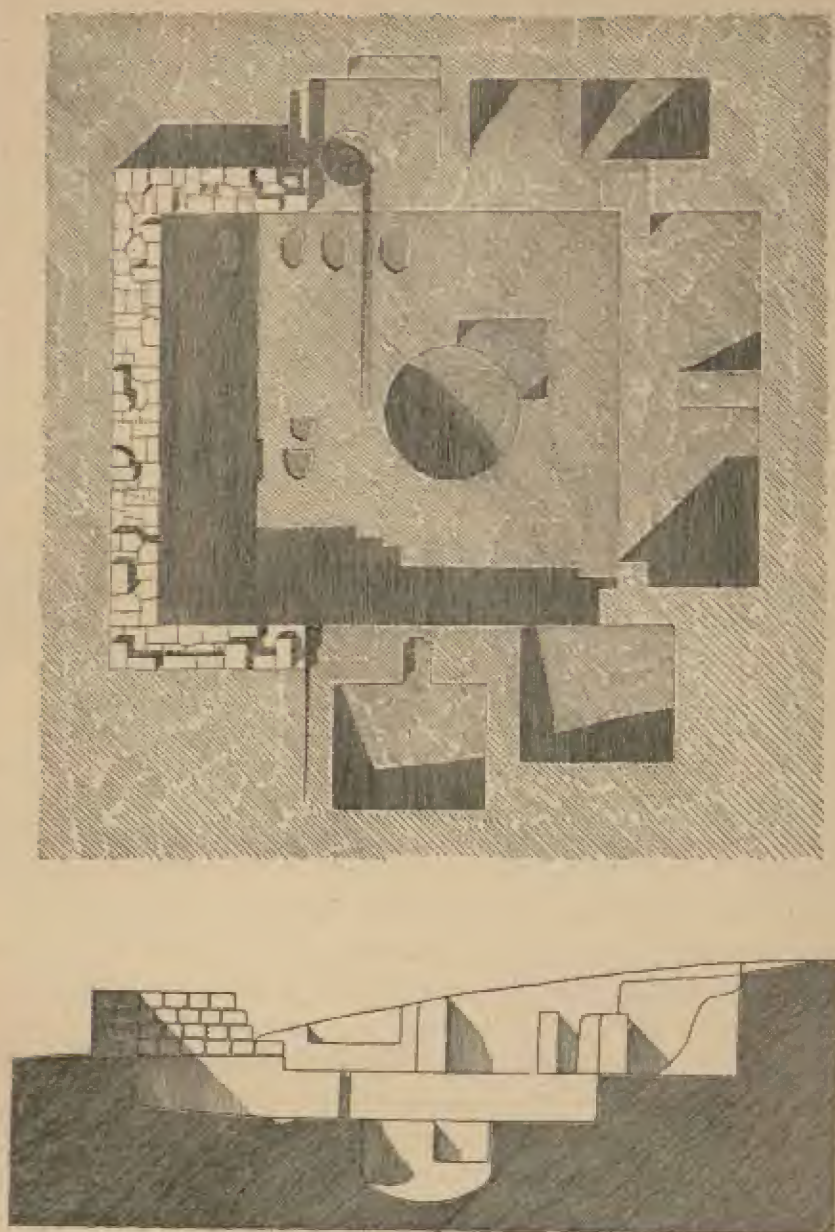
und 188. Hirbet umm el-Brač. El-Birce. Grundriß und Längsschnitt.
